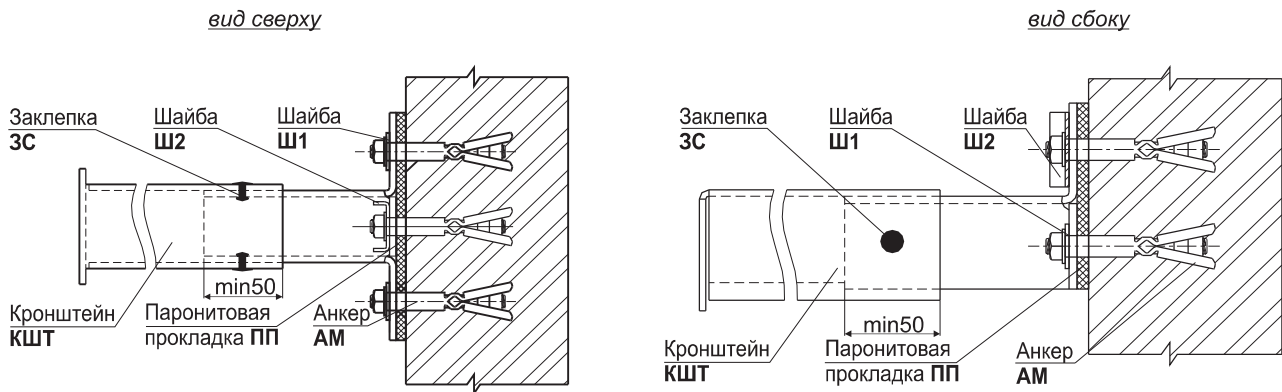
Узел крепления кронштейна КШТ (исполнение 1) к стене тремя анкерами.
